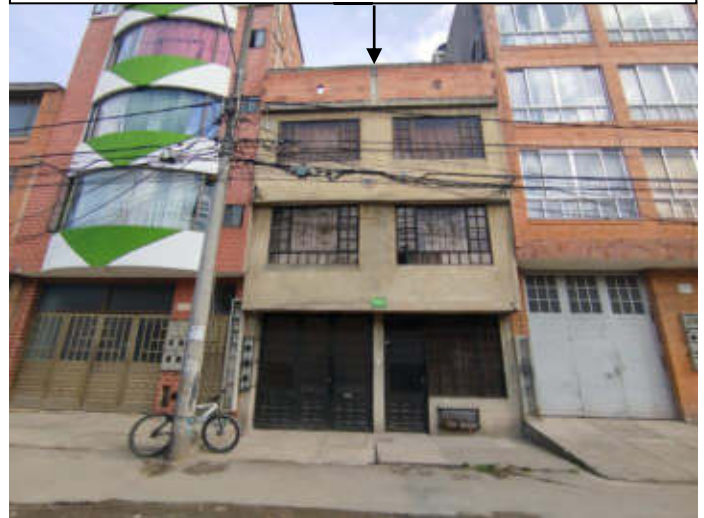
CONSTRUCCIONES EN PREDIO
